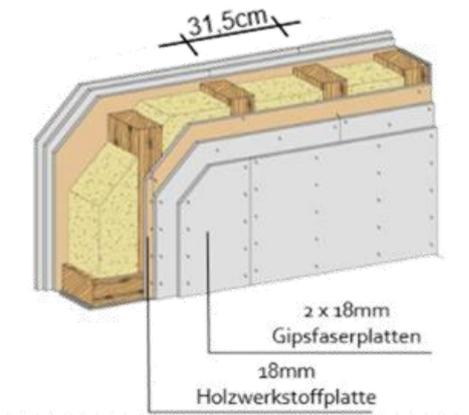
Wandaufbau für mechanisch-beanspruchte Wand mit Holzwerkstoffplatte 18mm [Fermacell]
